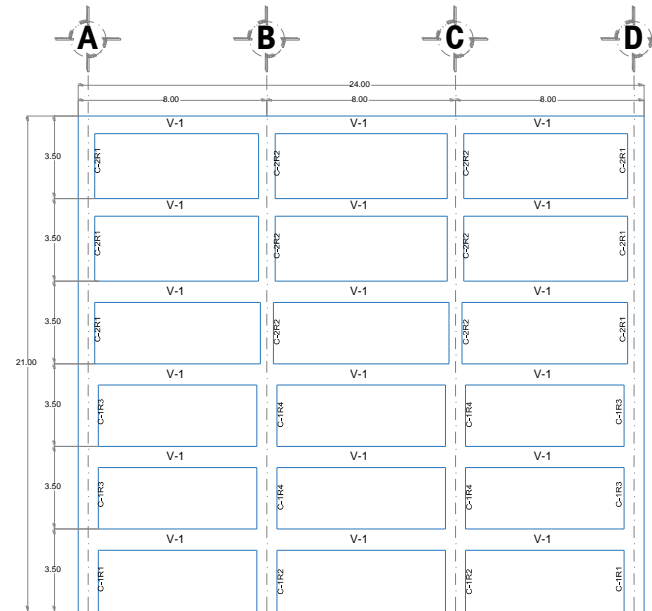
Alzado de armado de columnas y vigas de edificio de 6 niveles con base a la hipótesis de las NTCC-04.
